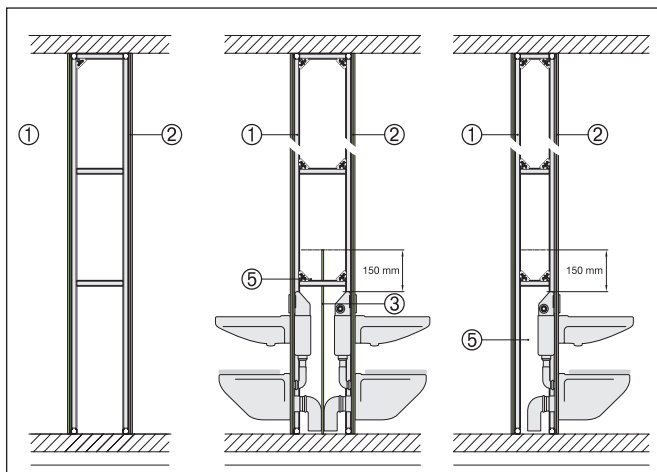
Schnitt durch eine Viega Installationstrennwand Eco Plus EI 120 (F 120) oder Steptec EI 120 (F 120) mit beidseitiger Installationsebene und Schachtinstallation nach dem Deckenabschottungsprinzip entsprechend den Viega ABP.
